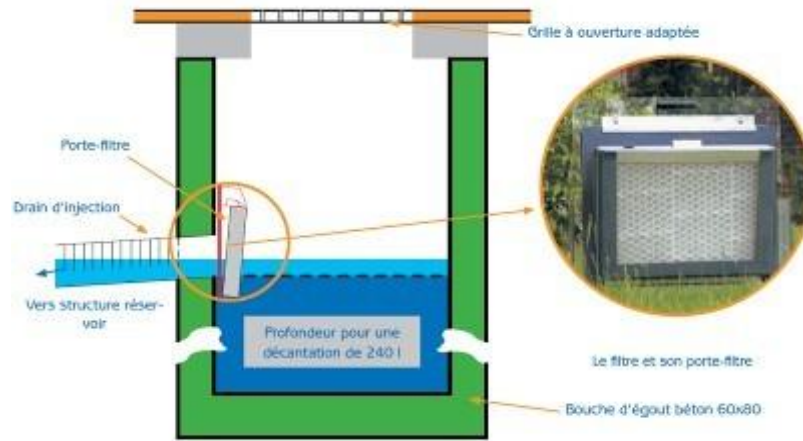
Exemple de dispositif d'engouffrement sélectif à filtre (ADOPTA)
